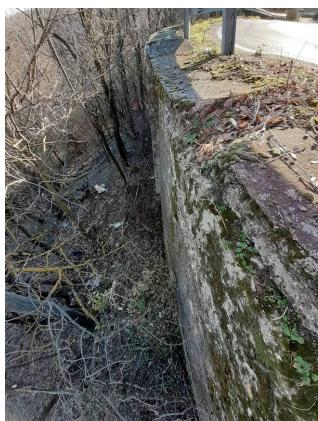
e Foto 8 - Viste del ribaltamento del muro
